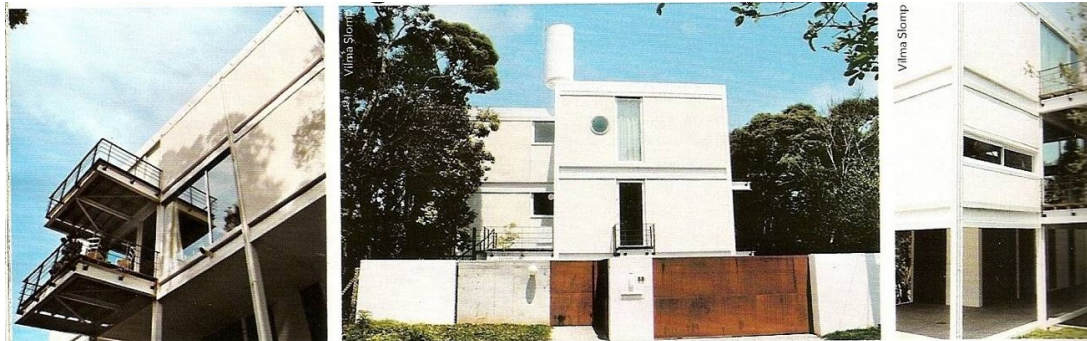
Exemplo de aplicação de placa cimentícia.
